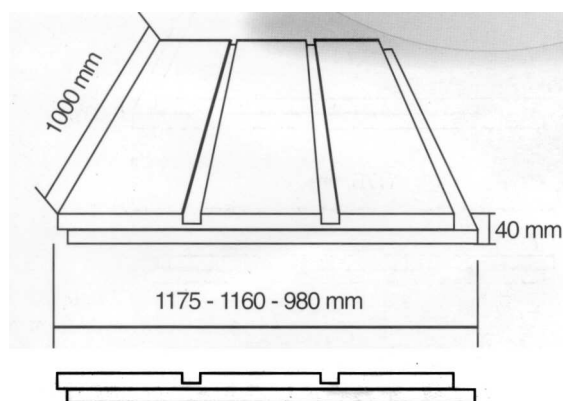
Detalle de las dimensiones habituales de estas planchas de EPS.
